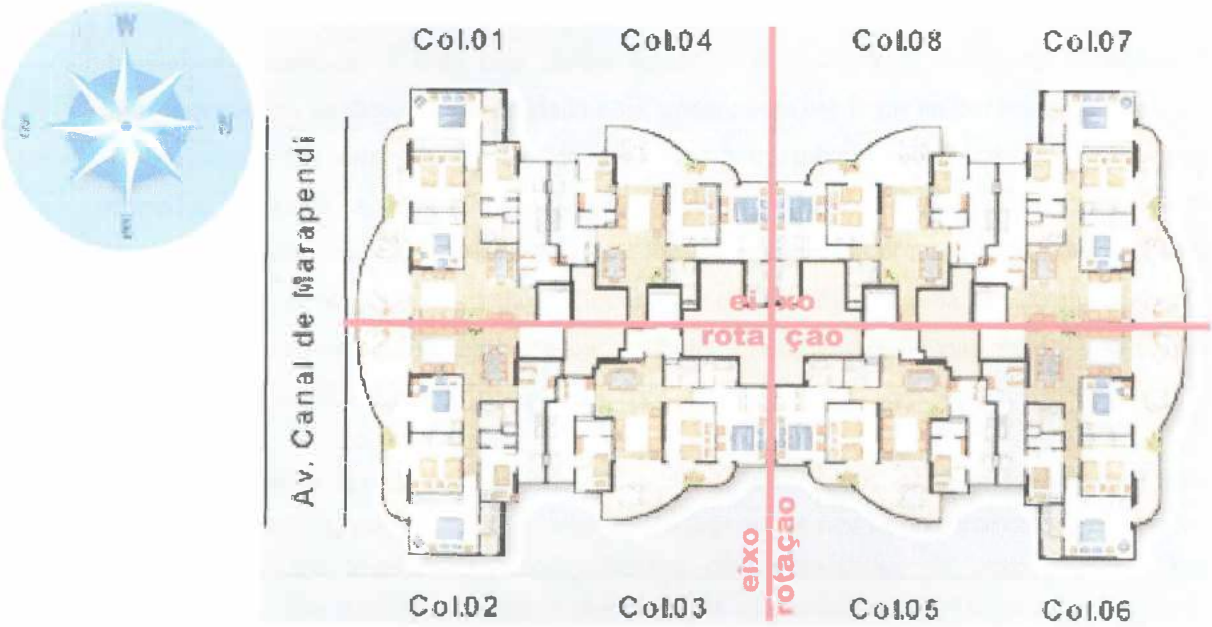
Planta Baixa típica da torre do condomínio Varandas do Mar
